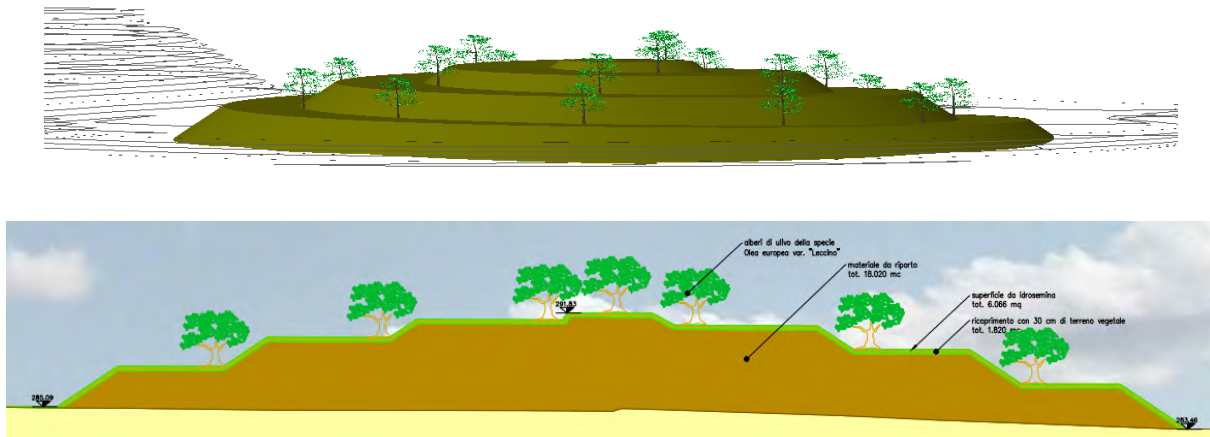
Vista tridimensionale e sezione tipologica (stralcio tavola di progetto)
